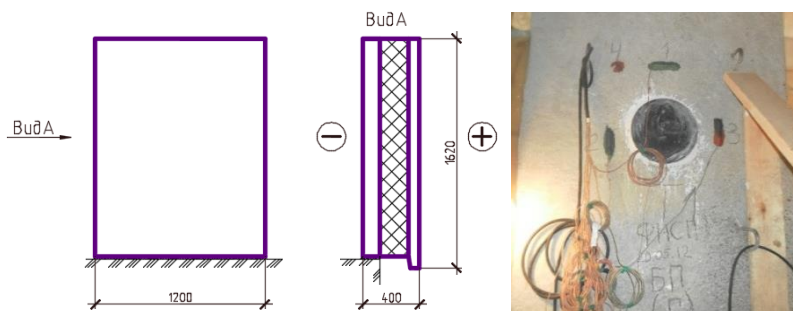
Схема испытательного образца в климатической камере с фотофиксацией общего вида
